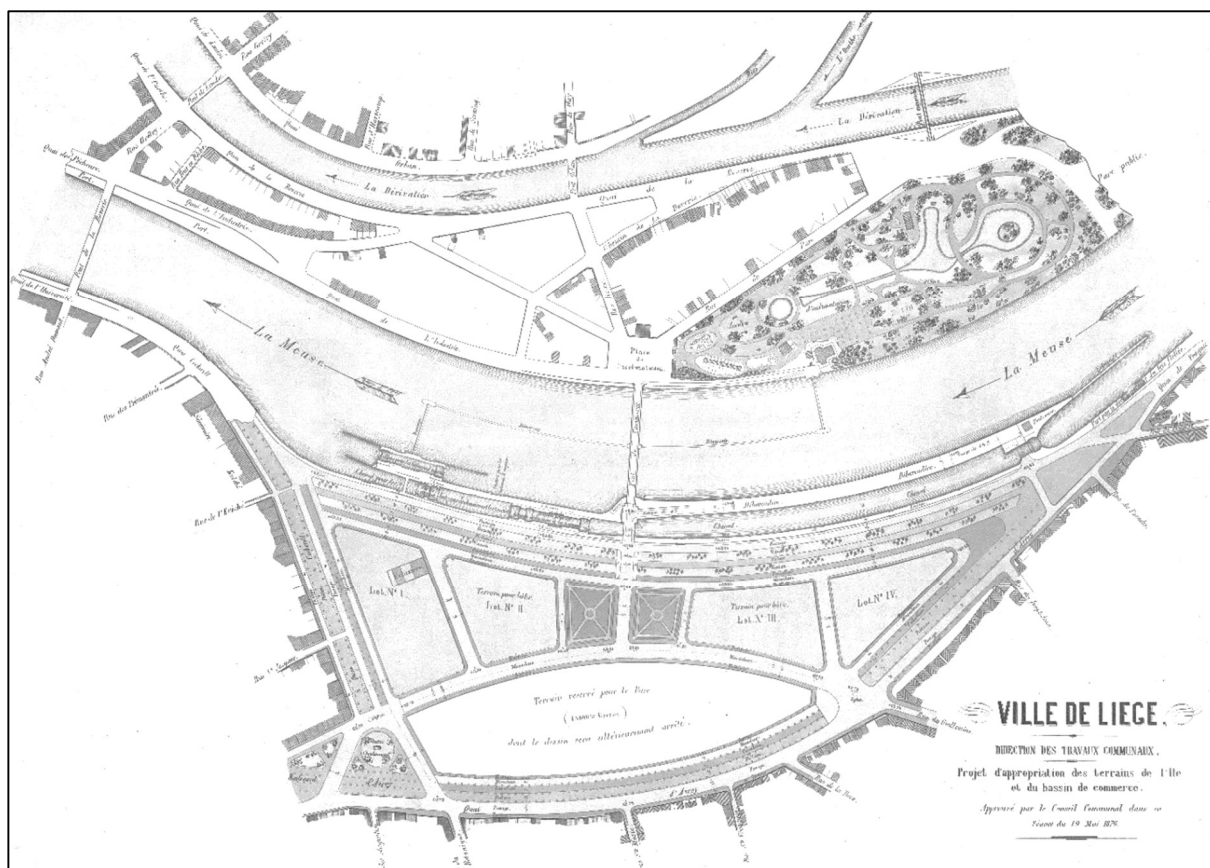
Illustration III : Extrait du plan du projet final de la ville BLONDEN – 1876
